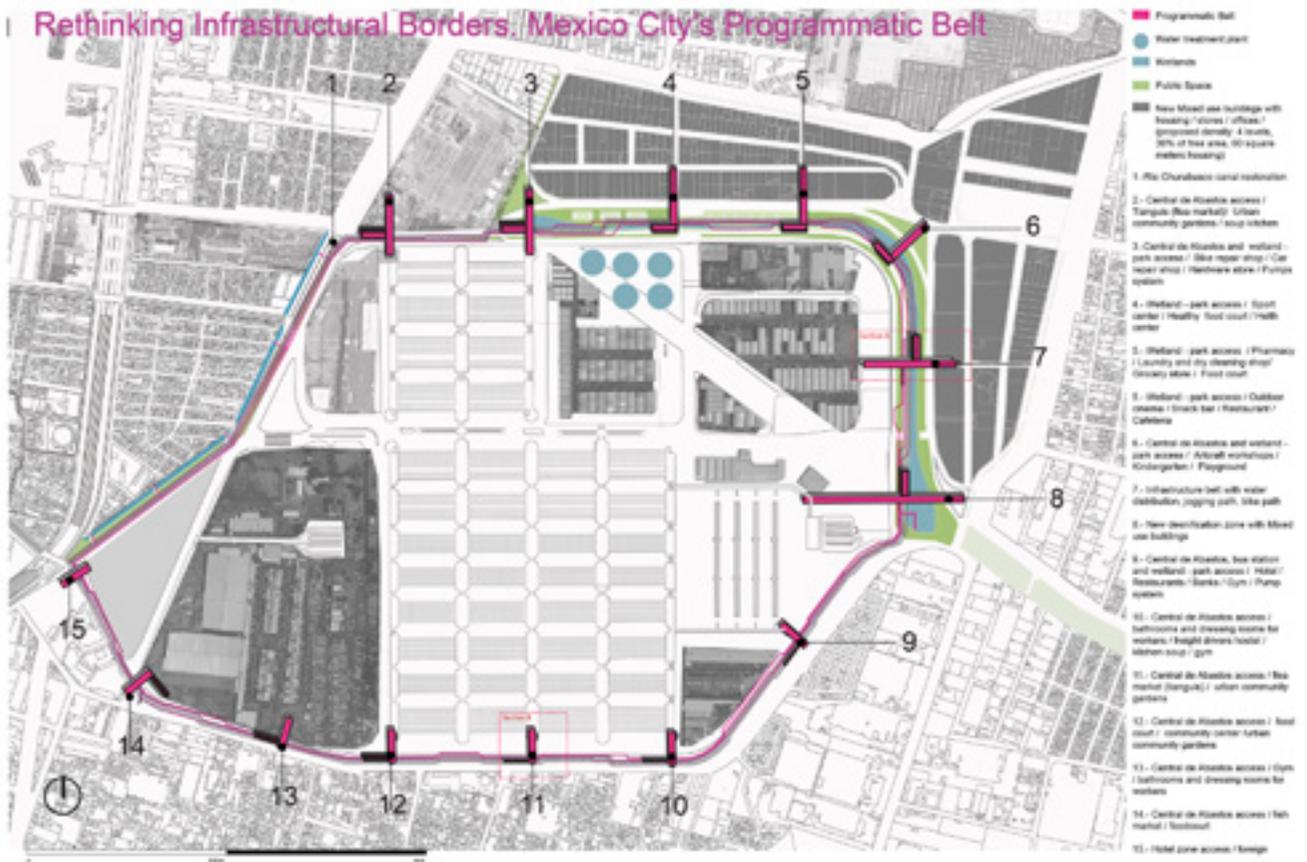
Planta arquitectónica del proyecto. Elaboración THU.
